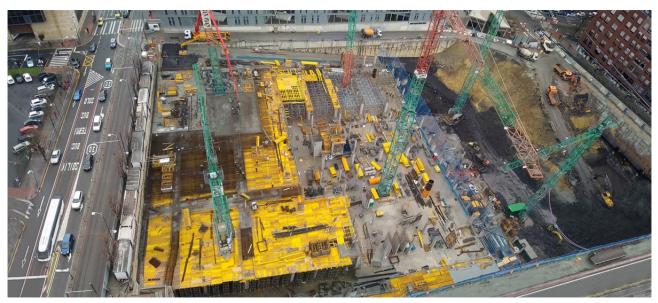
Fase de obra. Planteamiento de avance piramidal en bajo rasante zona izquierda.
